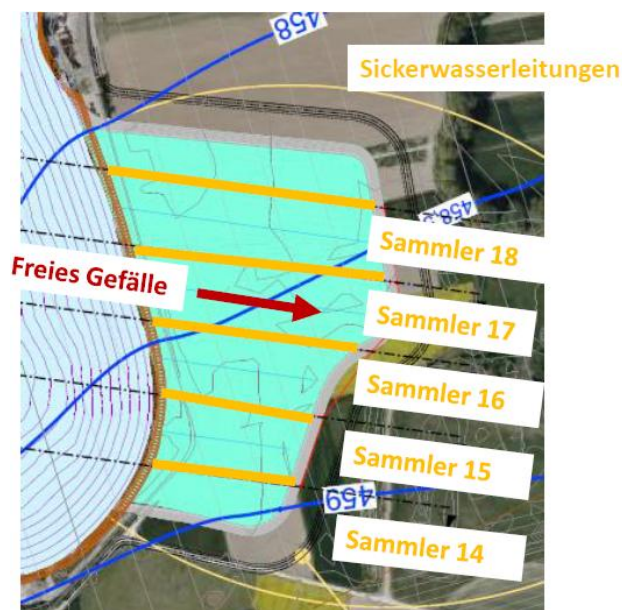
Ausführungsvariante Sickerwasserfassung vorgelagerte Erweiterung
